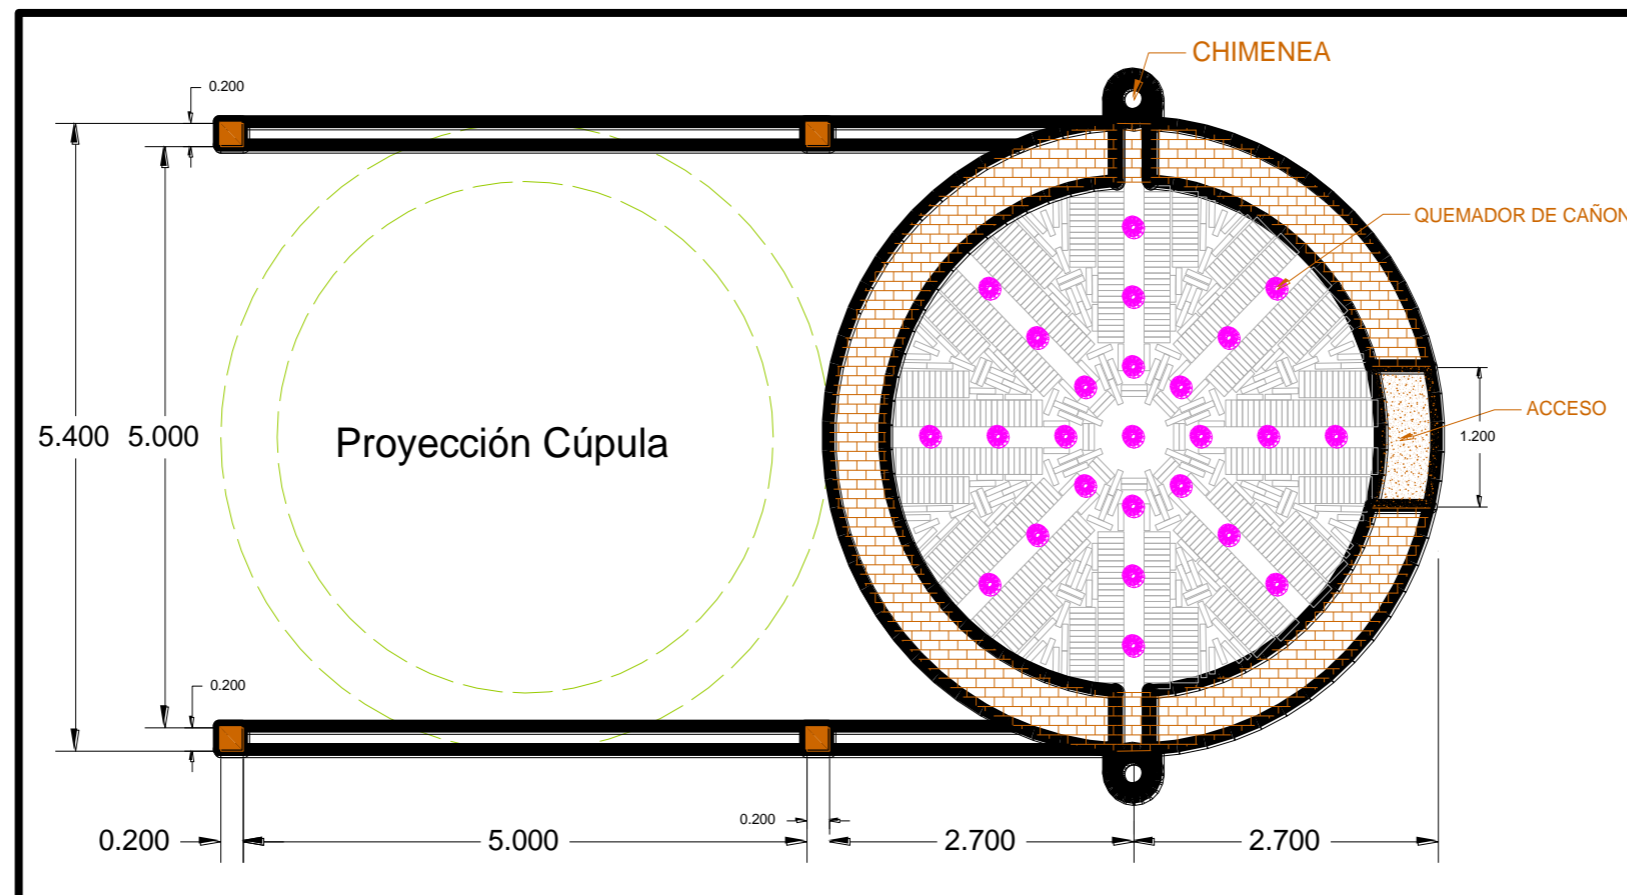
PLANTA ARQUITECTÓNICA - PROPUESTA "C".
